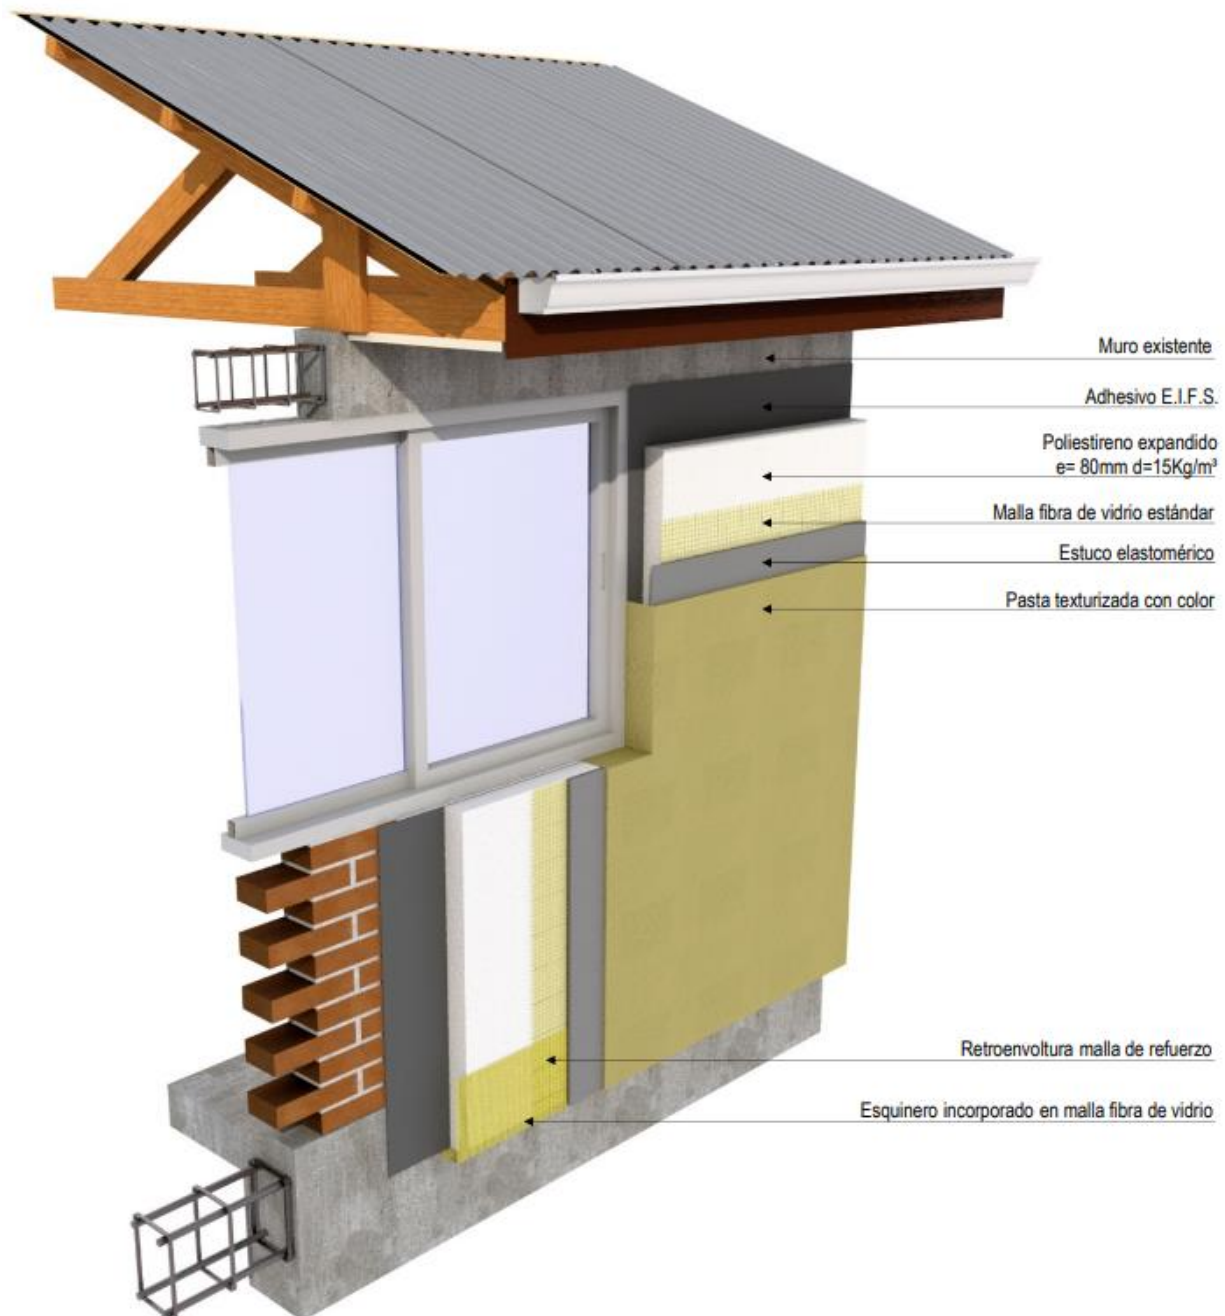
Esquema de aislación tipo EIFS sobre muro de albañilería para zona térmica F⁴
